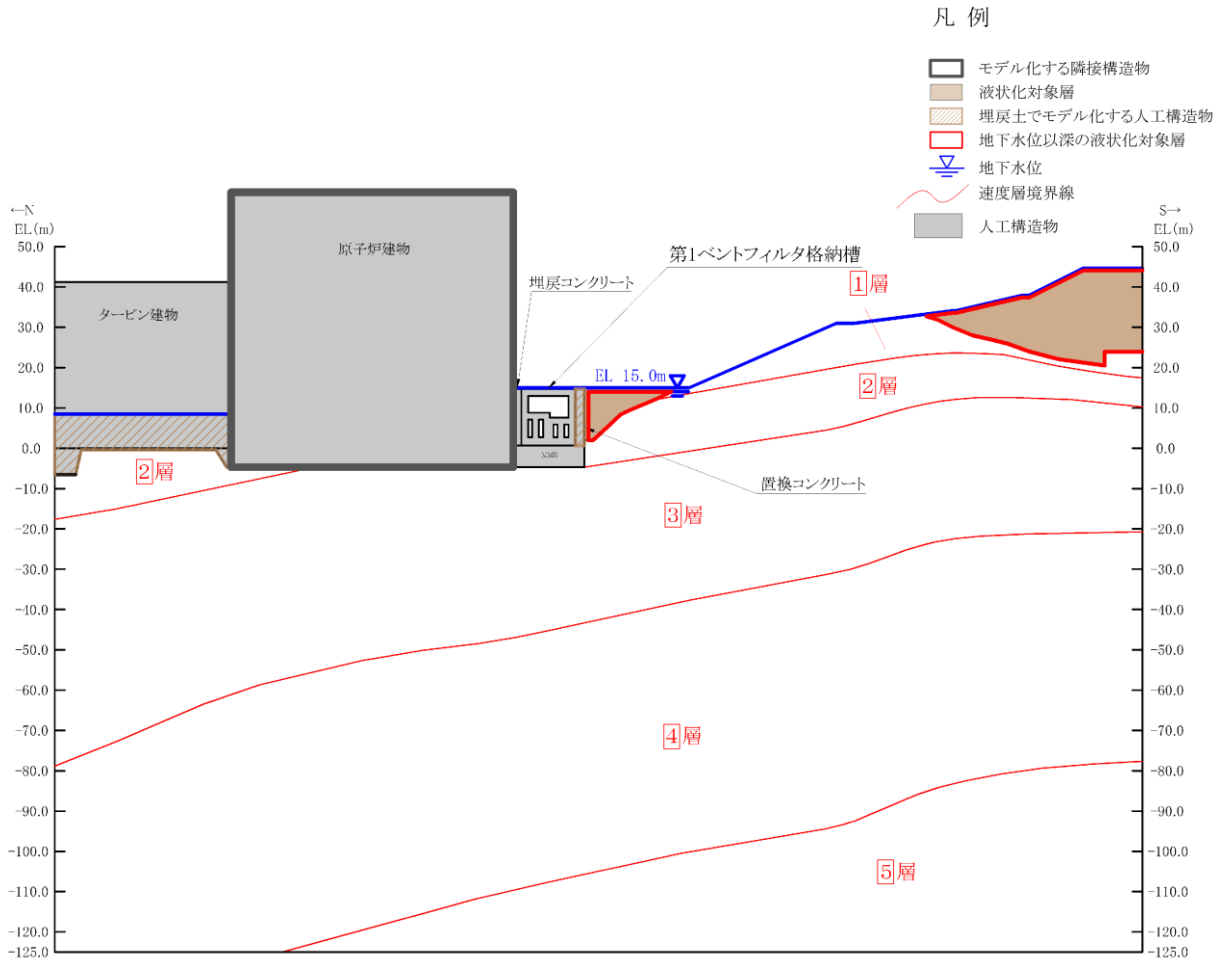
第 1 ベントフィルタ格納槽 評価対象断面図 (B-B 断面位置)
